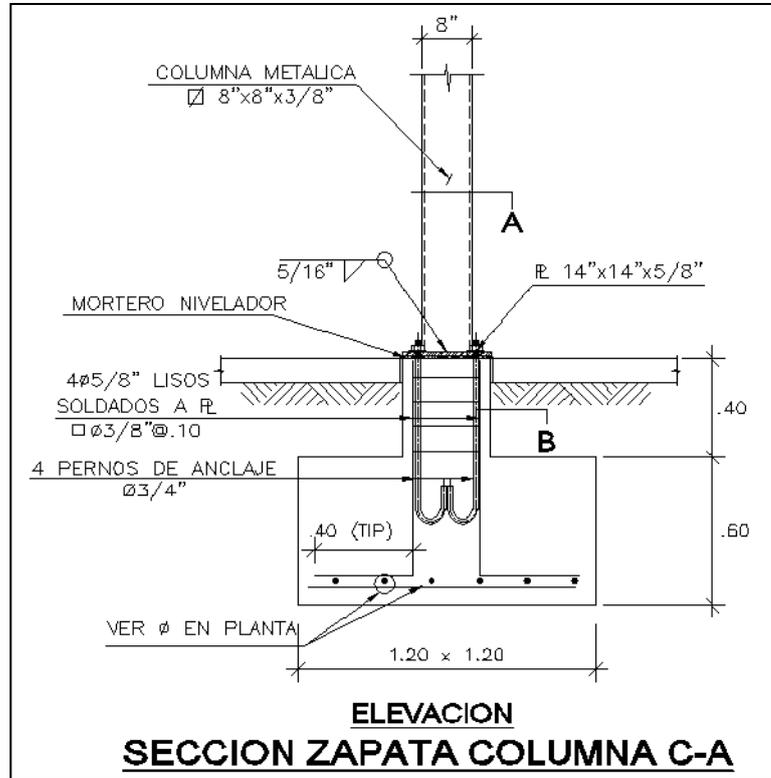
Sección de zapata. FUENTE: Elaboración Propia
